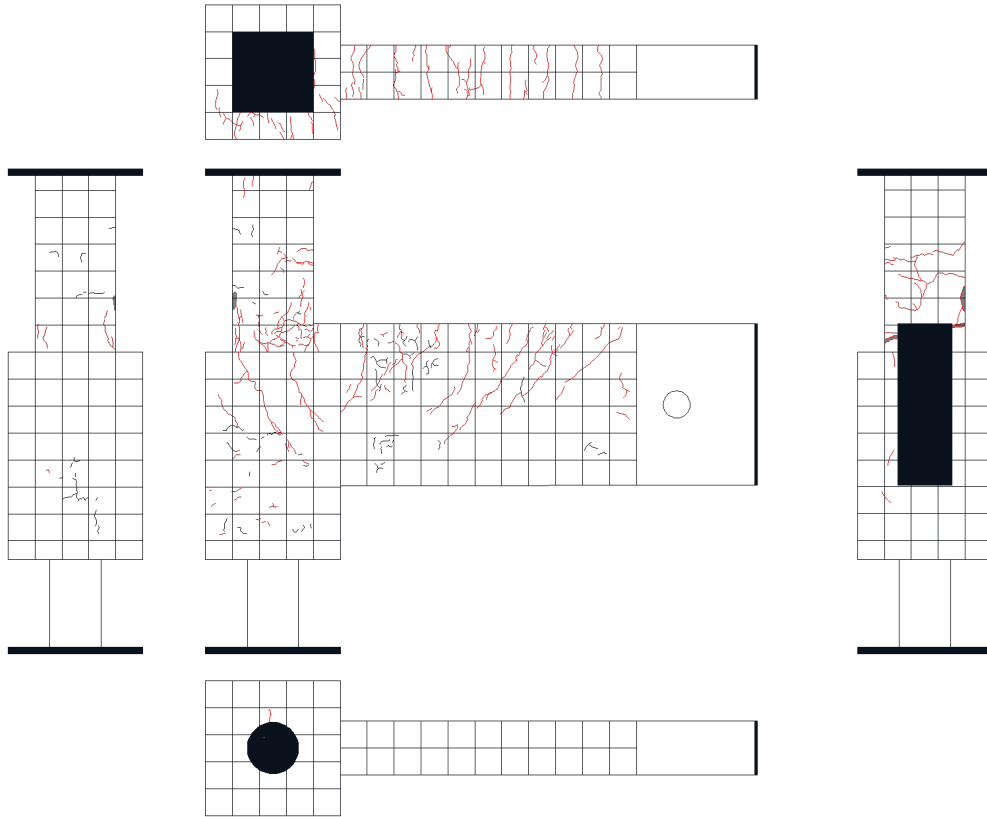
3. 169 試験体 D-1 ひび割れ状況 (6Cycle)
